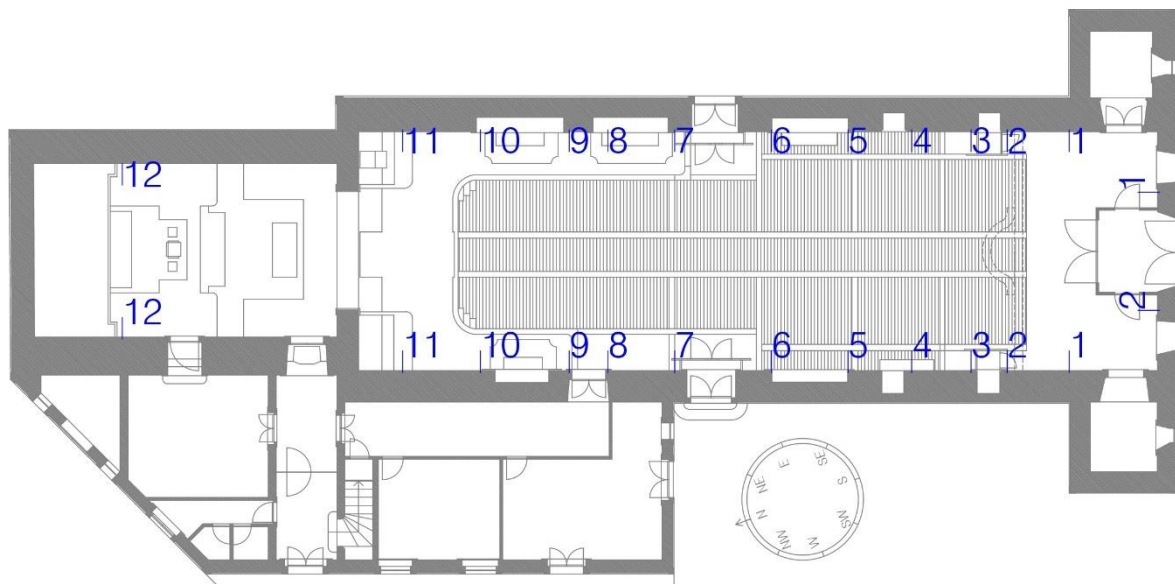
Planta piso 0 - localização do levantamento
